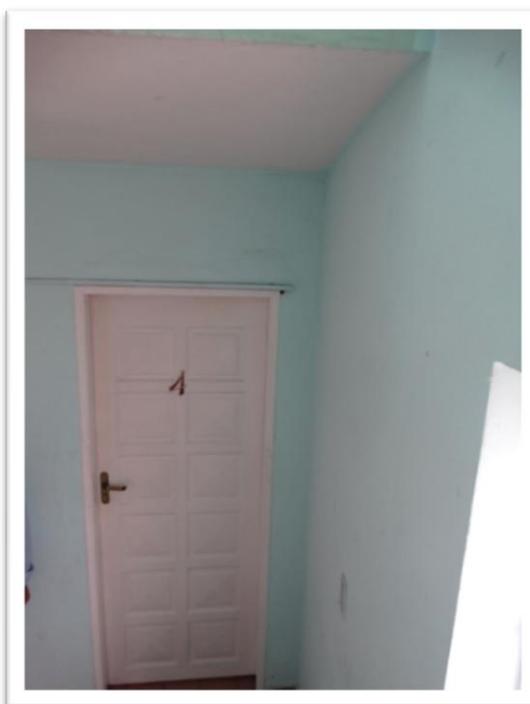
Vista parcial do imóvel objeto da vistoria – Porta de acesso ao Apartamento nº 4.
